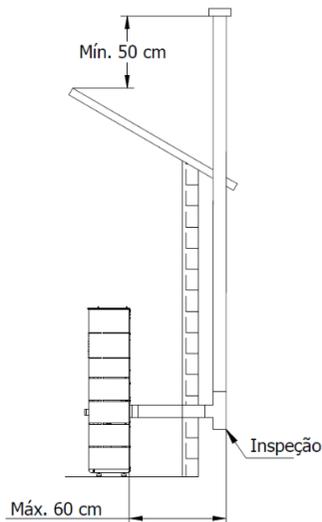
Vista lateral da instalação sem chaminé, com exemplo do ponto de inspeção
